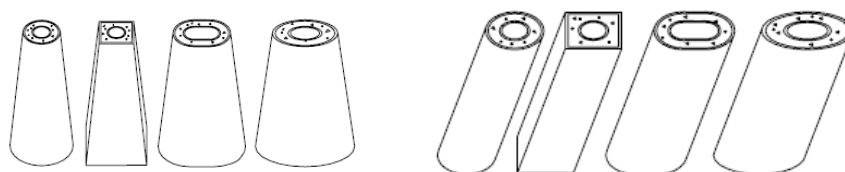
Vista esquemática: nuevas secciones en doble piel
